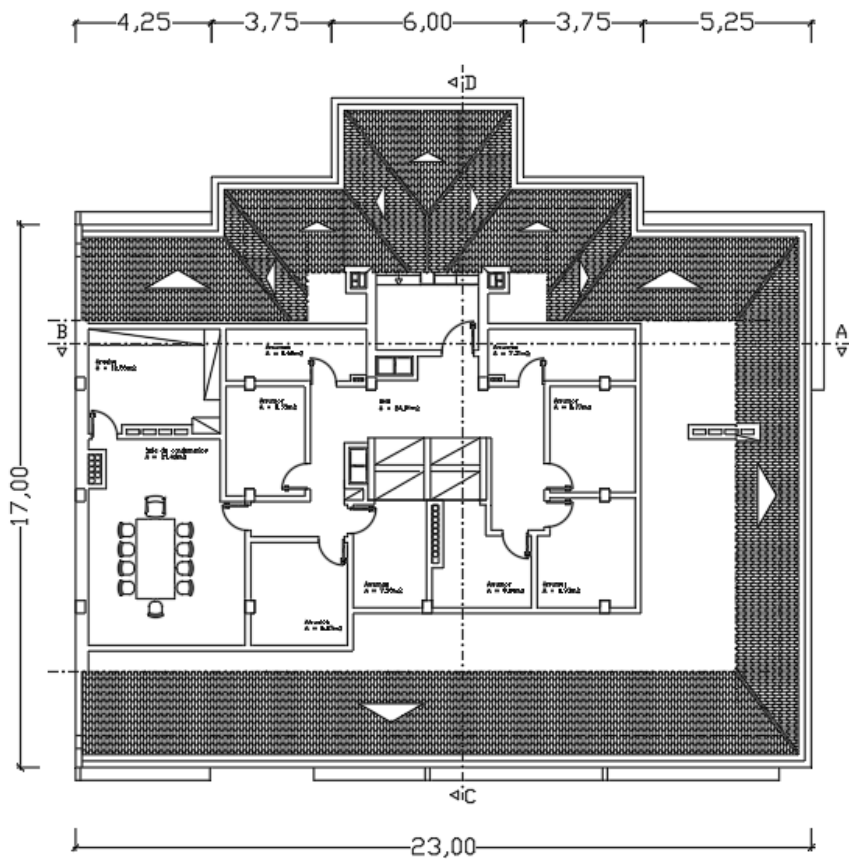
Planta arquitetônica do sótão (AutoCad).
